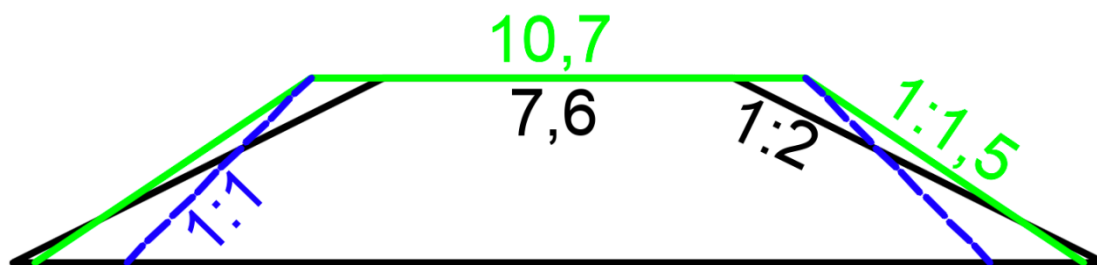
Очертание насыпи из скальных и песчаных грунтов
